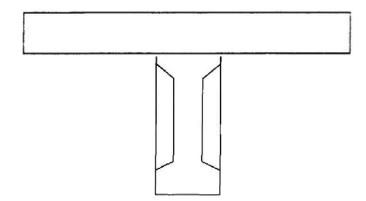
Poutre en I avec épaississement rectangulaire aux abouts
